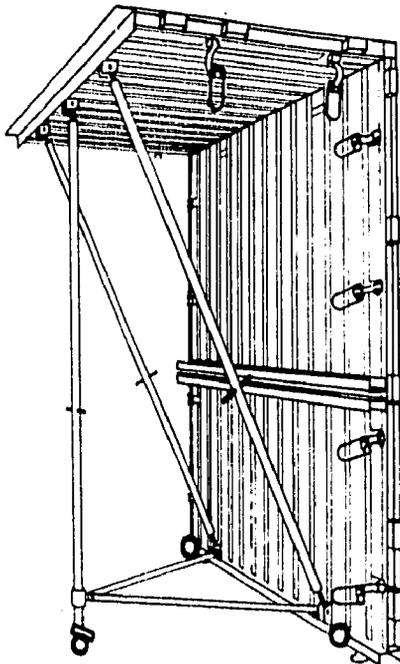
PROTOTIPO I ENCOFRADO TÚNEL MURO INTERIOR
